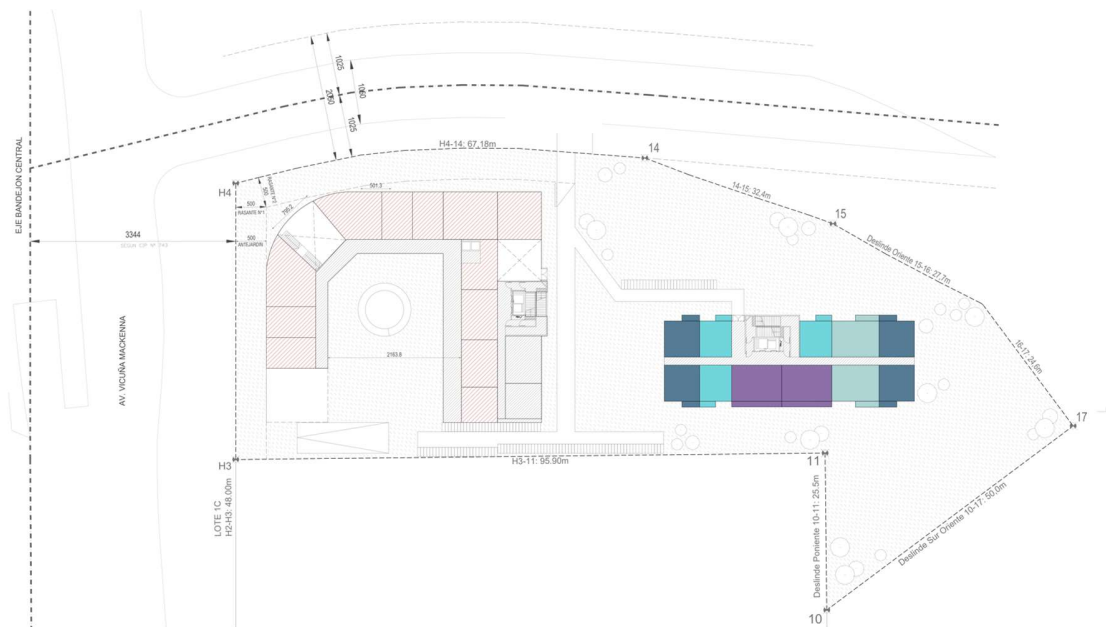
Plano 2° piso. Fuente: Elaboración propia
